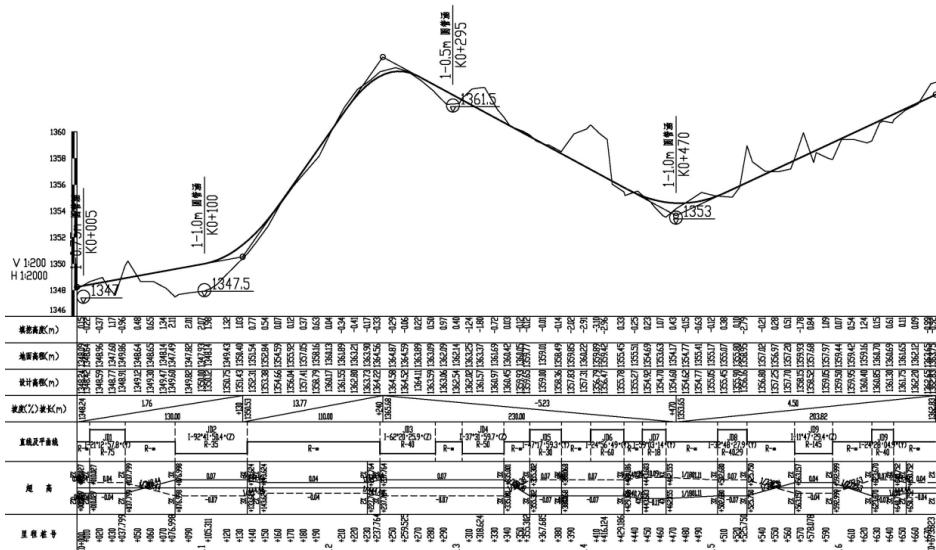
天麻基地至英雄山公路主线道路纵断面图
